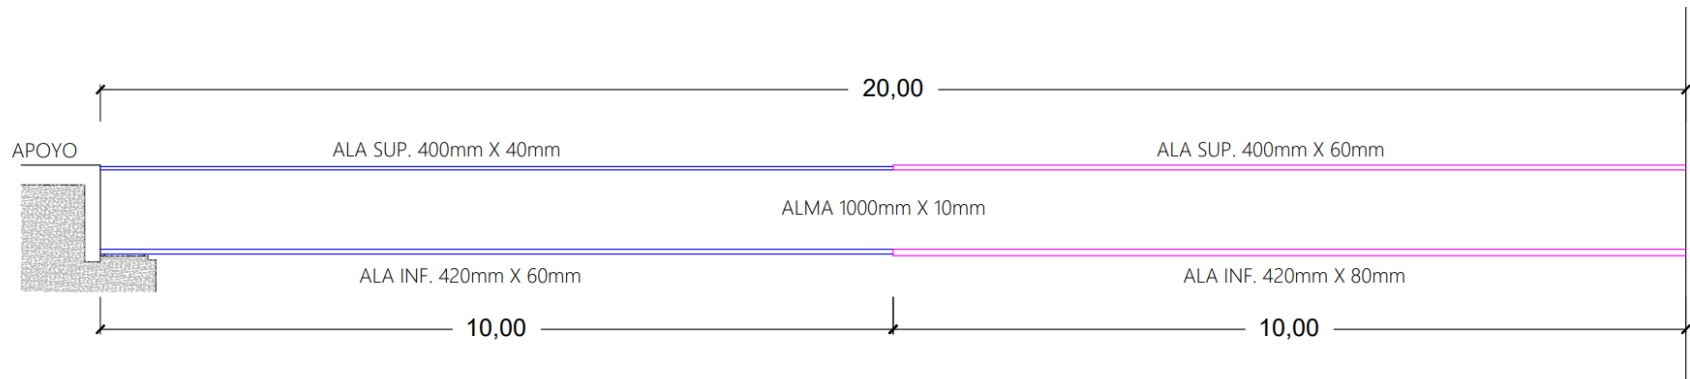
Dimensiones de la viga de acero en la mitad del vano.
